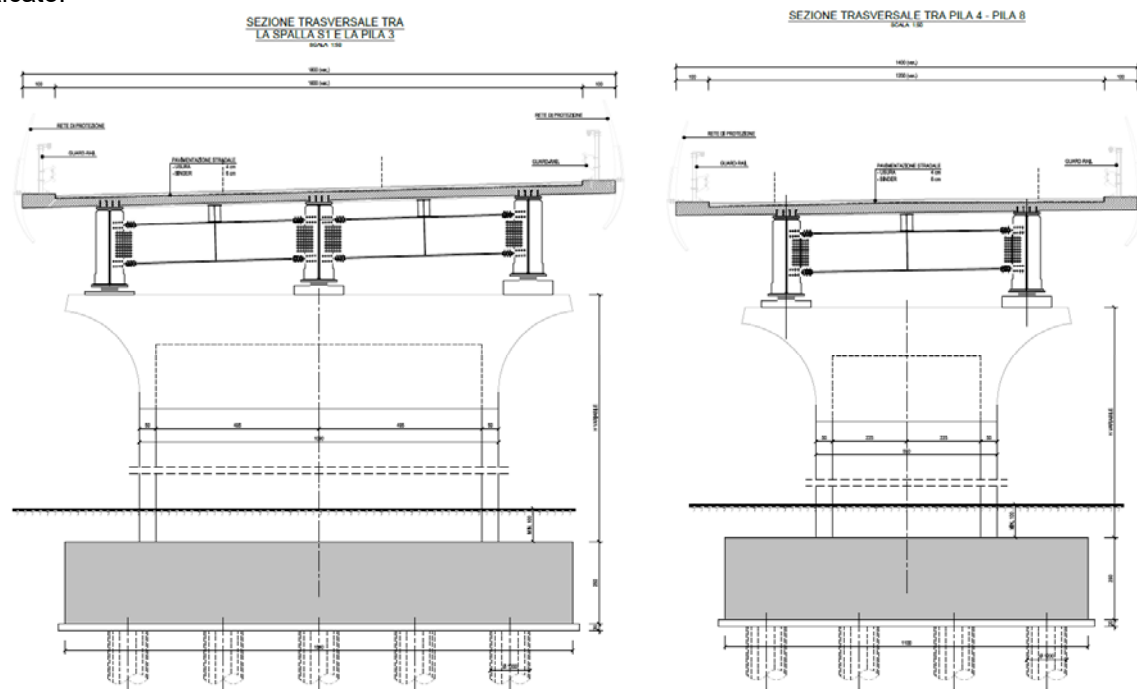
Viadotto Serra Paducci Rampa 2: sezione impalcato/pile (le due tipologie)
